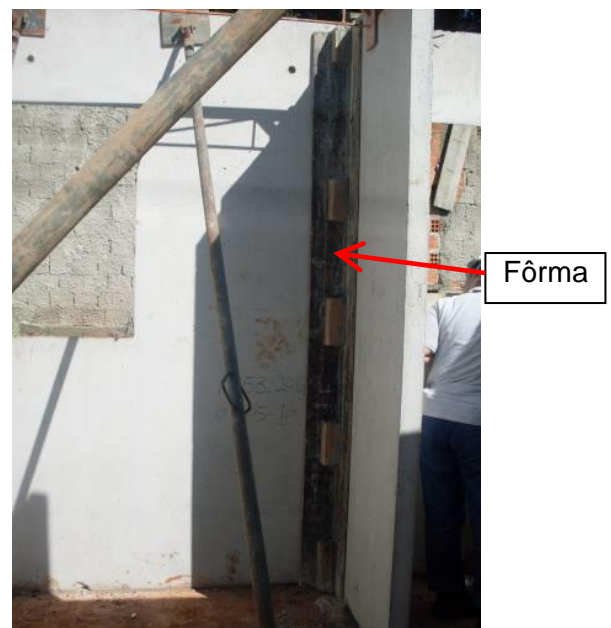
Fôrma para grauteamento da ligação dos painéis
